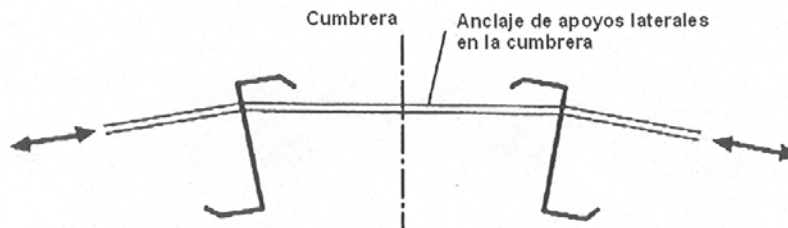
Detalle de anclaje de apoyos laterales en cumbrera.
